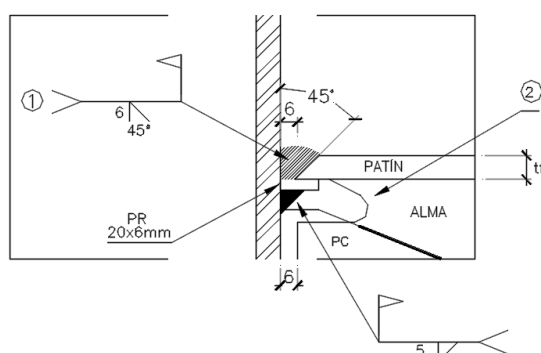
Detalle de soldadura viga-columna del patín superior
